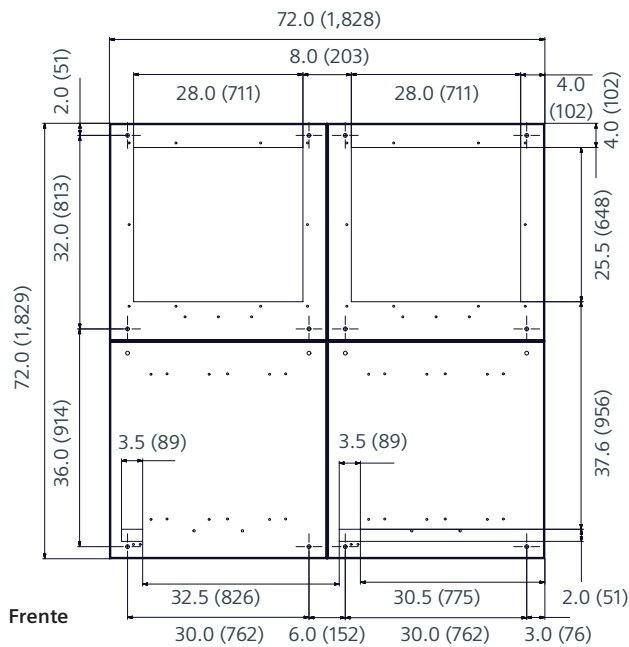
Planos de planta típicos para el interruptor SIEBREAK
